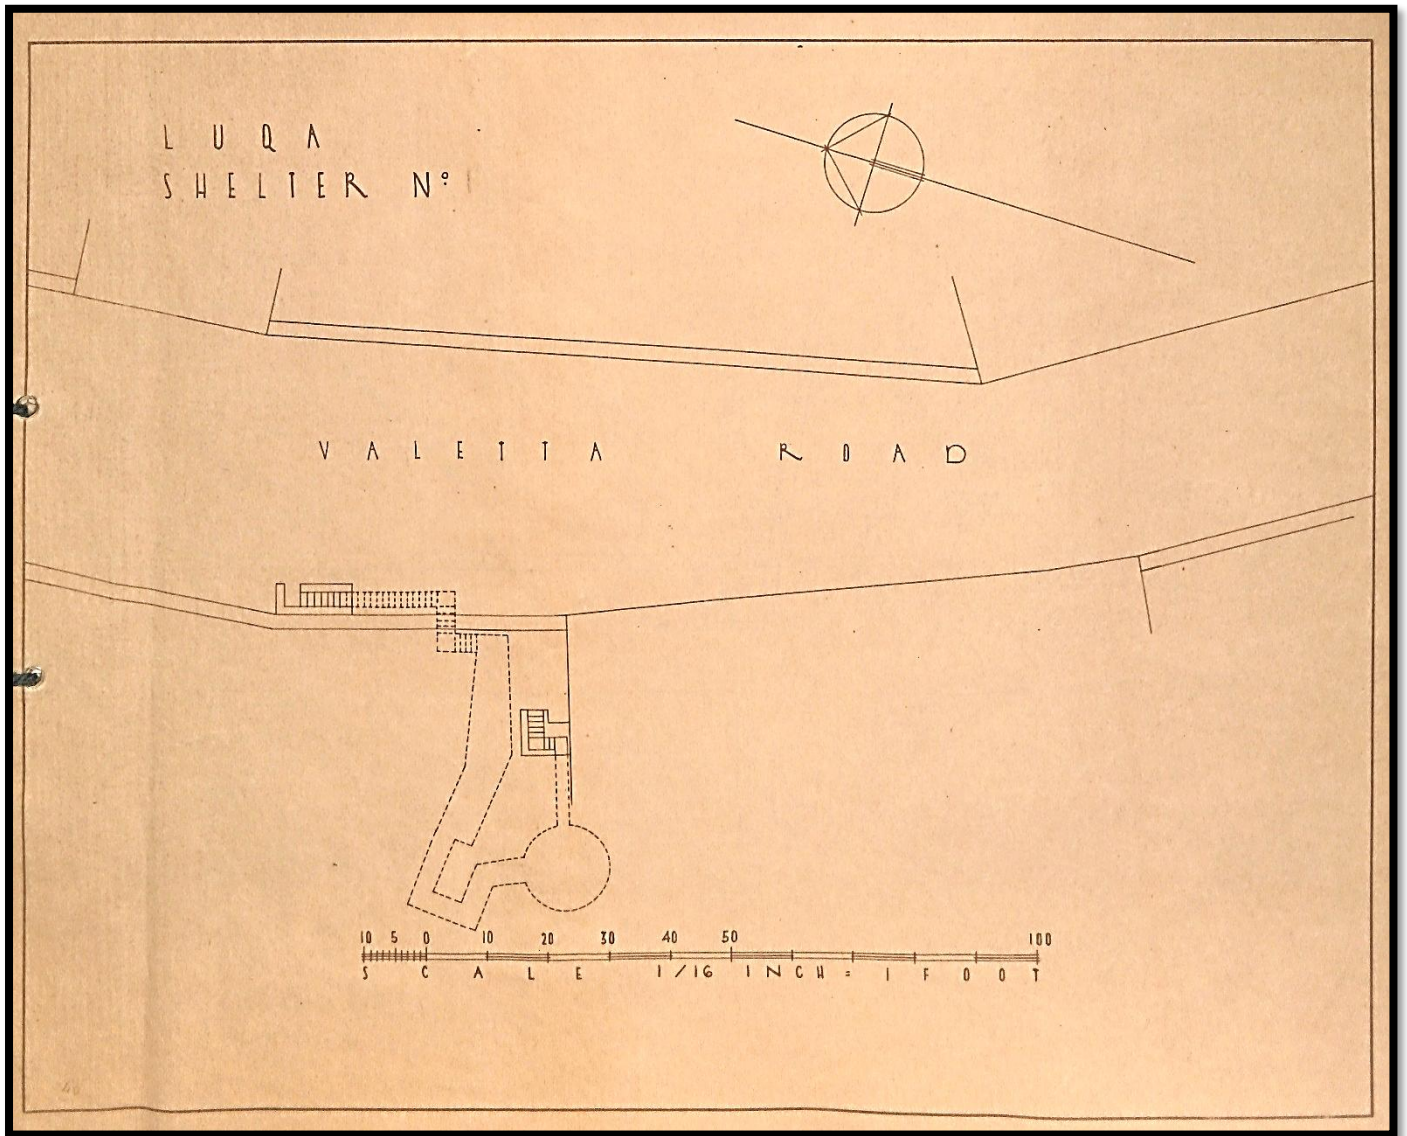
Planta do Abrigo nº1 "Valetta Road"
